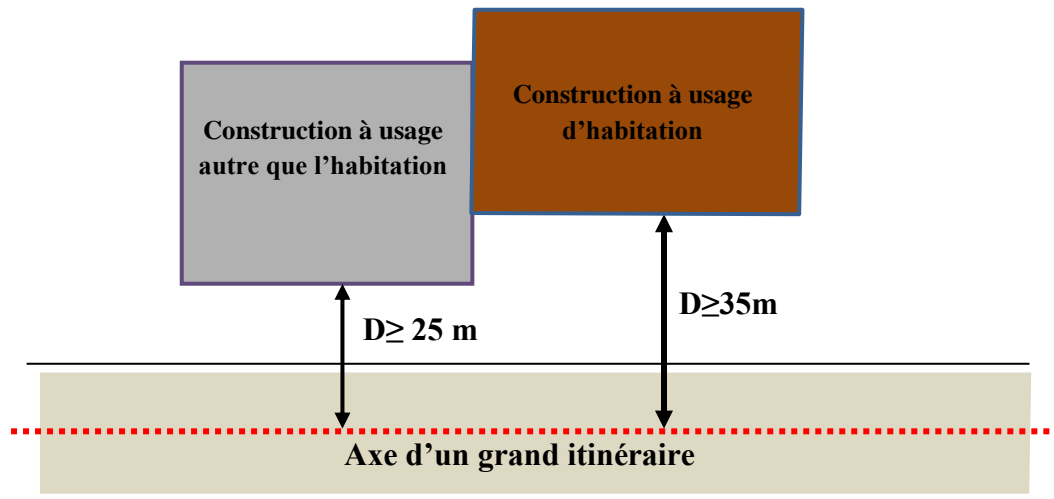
Vue en Plan définissant le recul ou la servitude d'une construction par rapport à un grand itinéraire.
